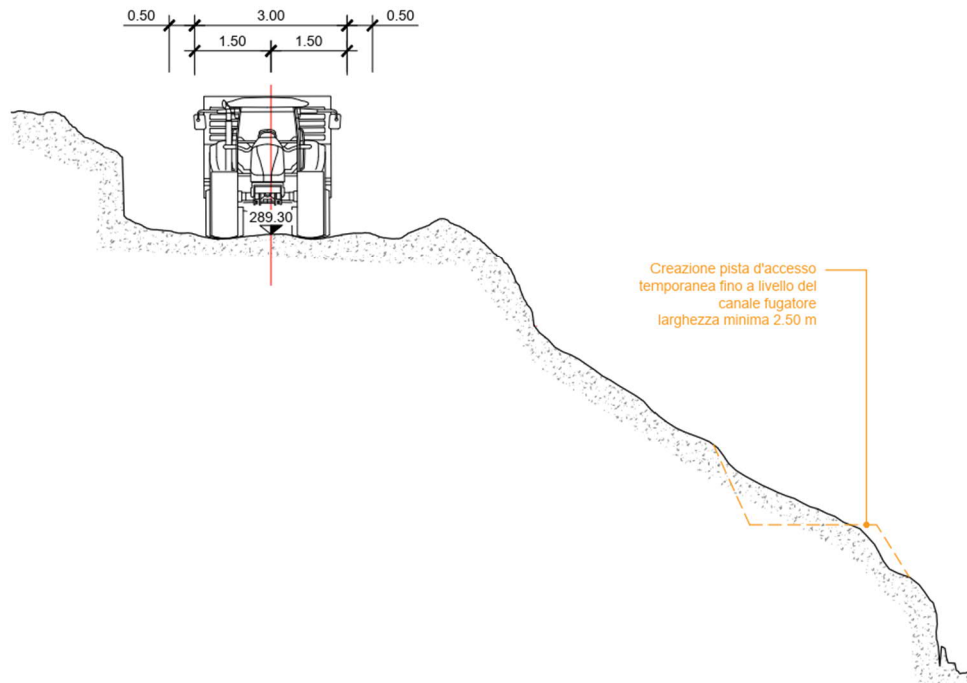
Sezione A-A estratta dal piano "02 - Piano dell'intervento"
